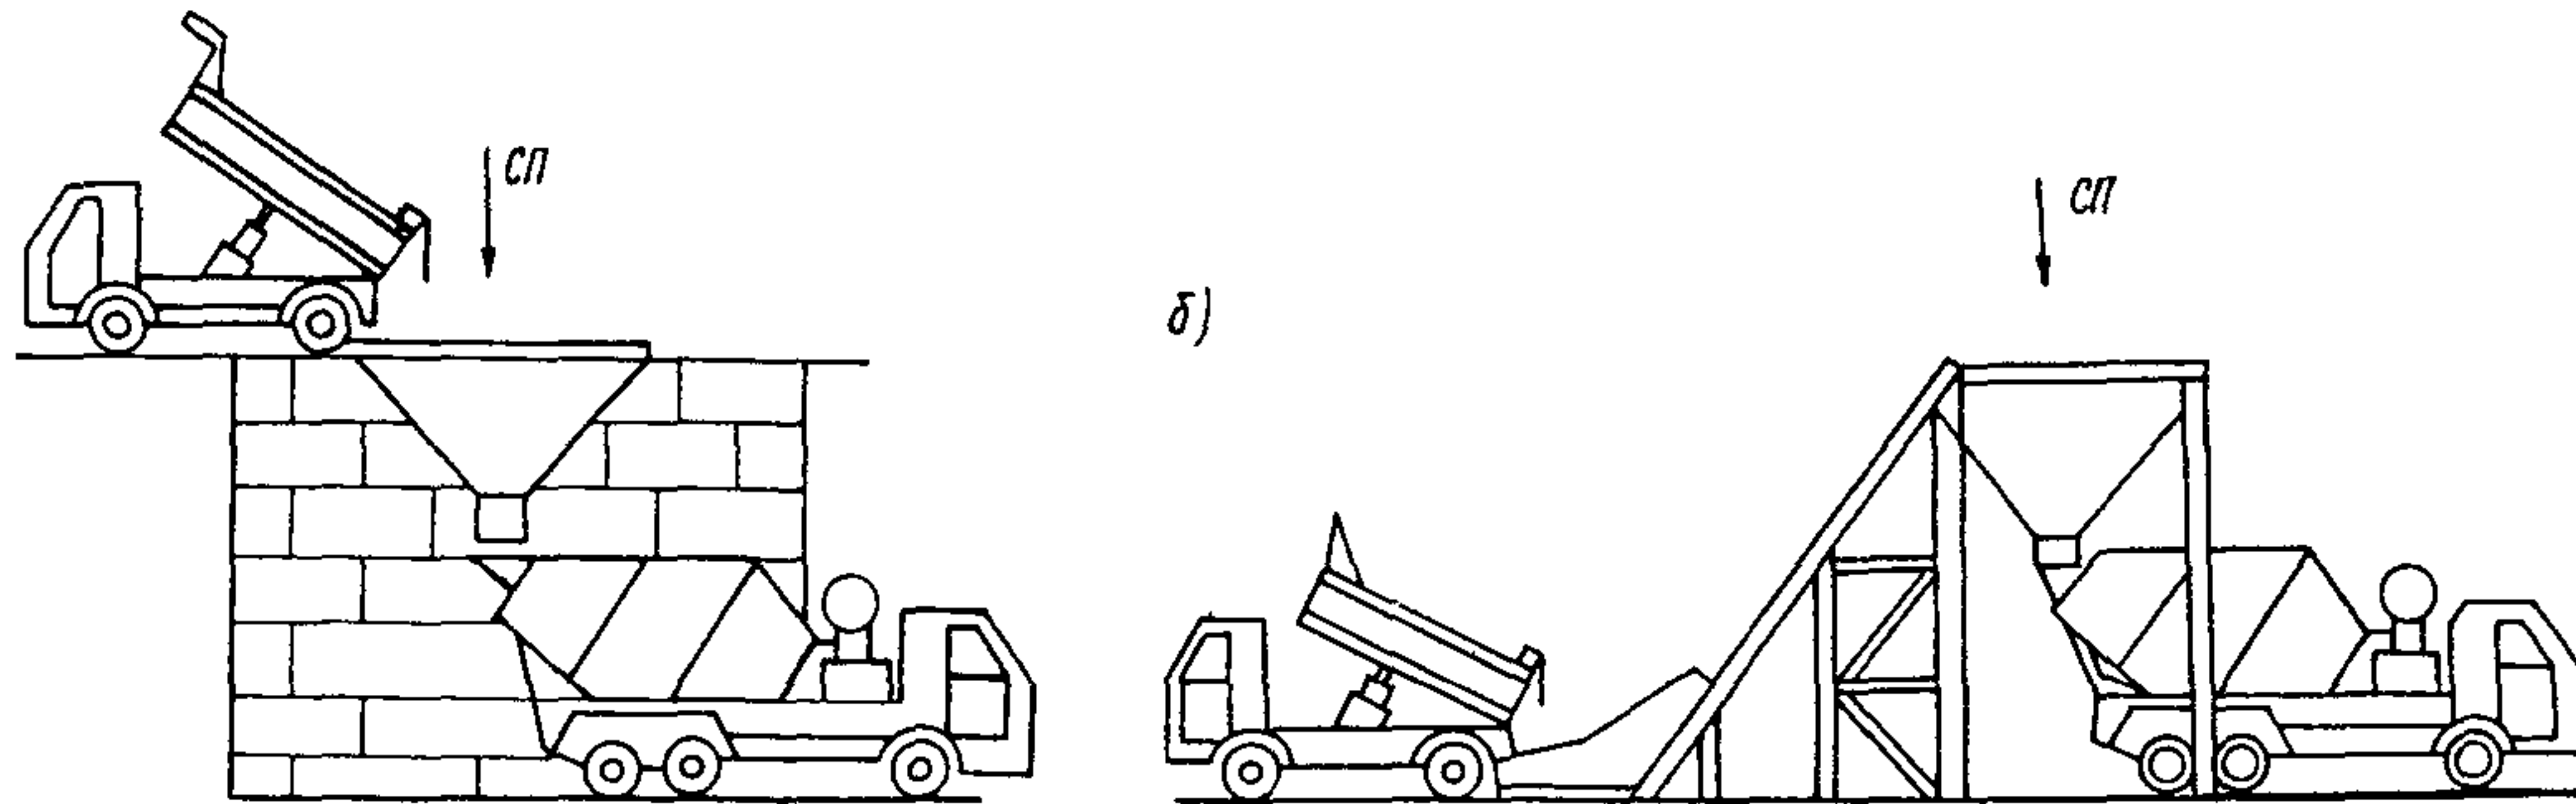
Рис. I. Принципиальные схемы доставки бетонной смеси к месту укладки
